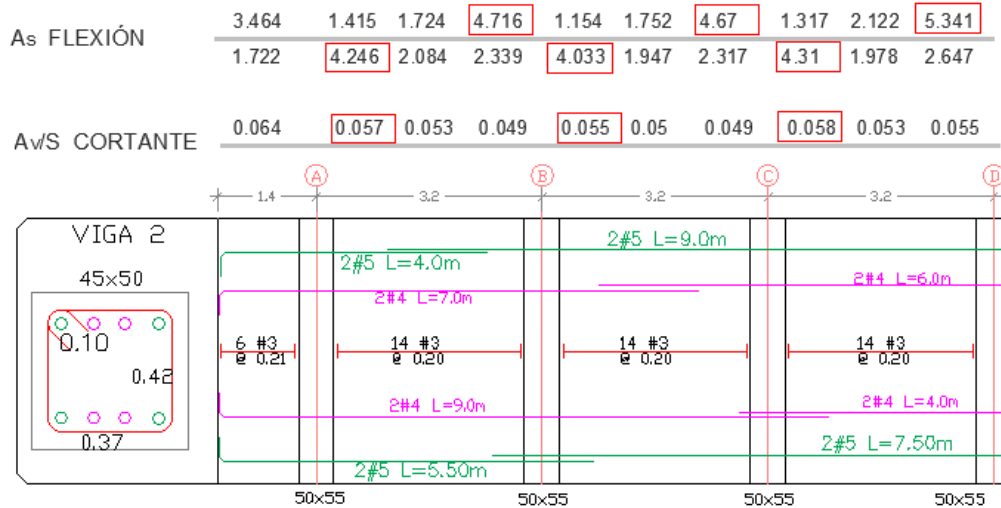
Cuantías obtenidas por esfuerzo a flexión, cortante y despiece de la viga 2 de la planta estructural.
